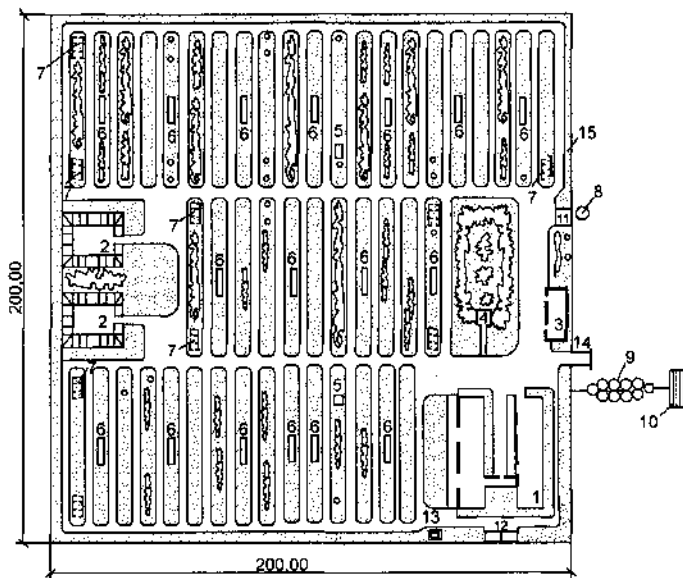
Схема генерального плана пчеловодческой фермы на 4800 пчелиных семей:
